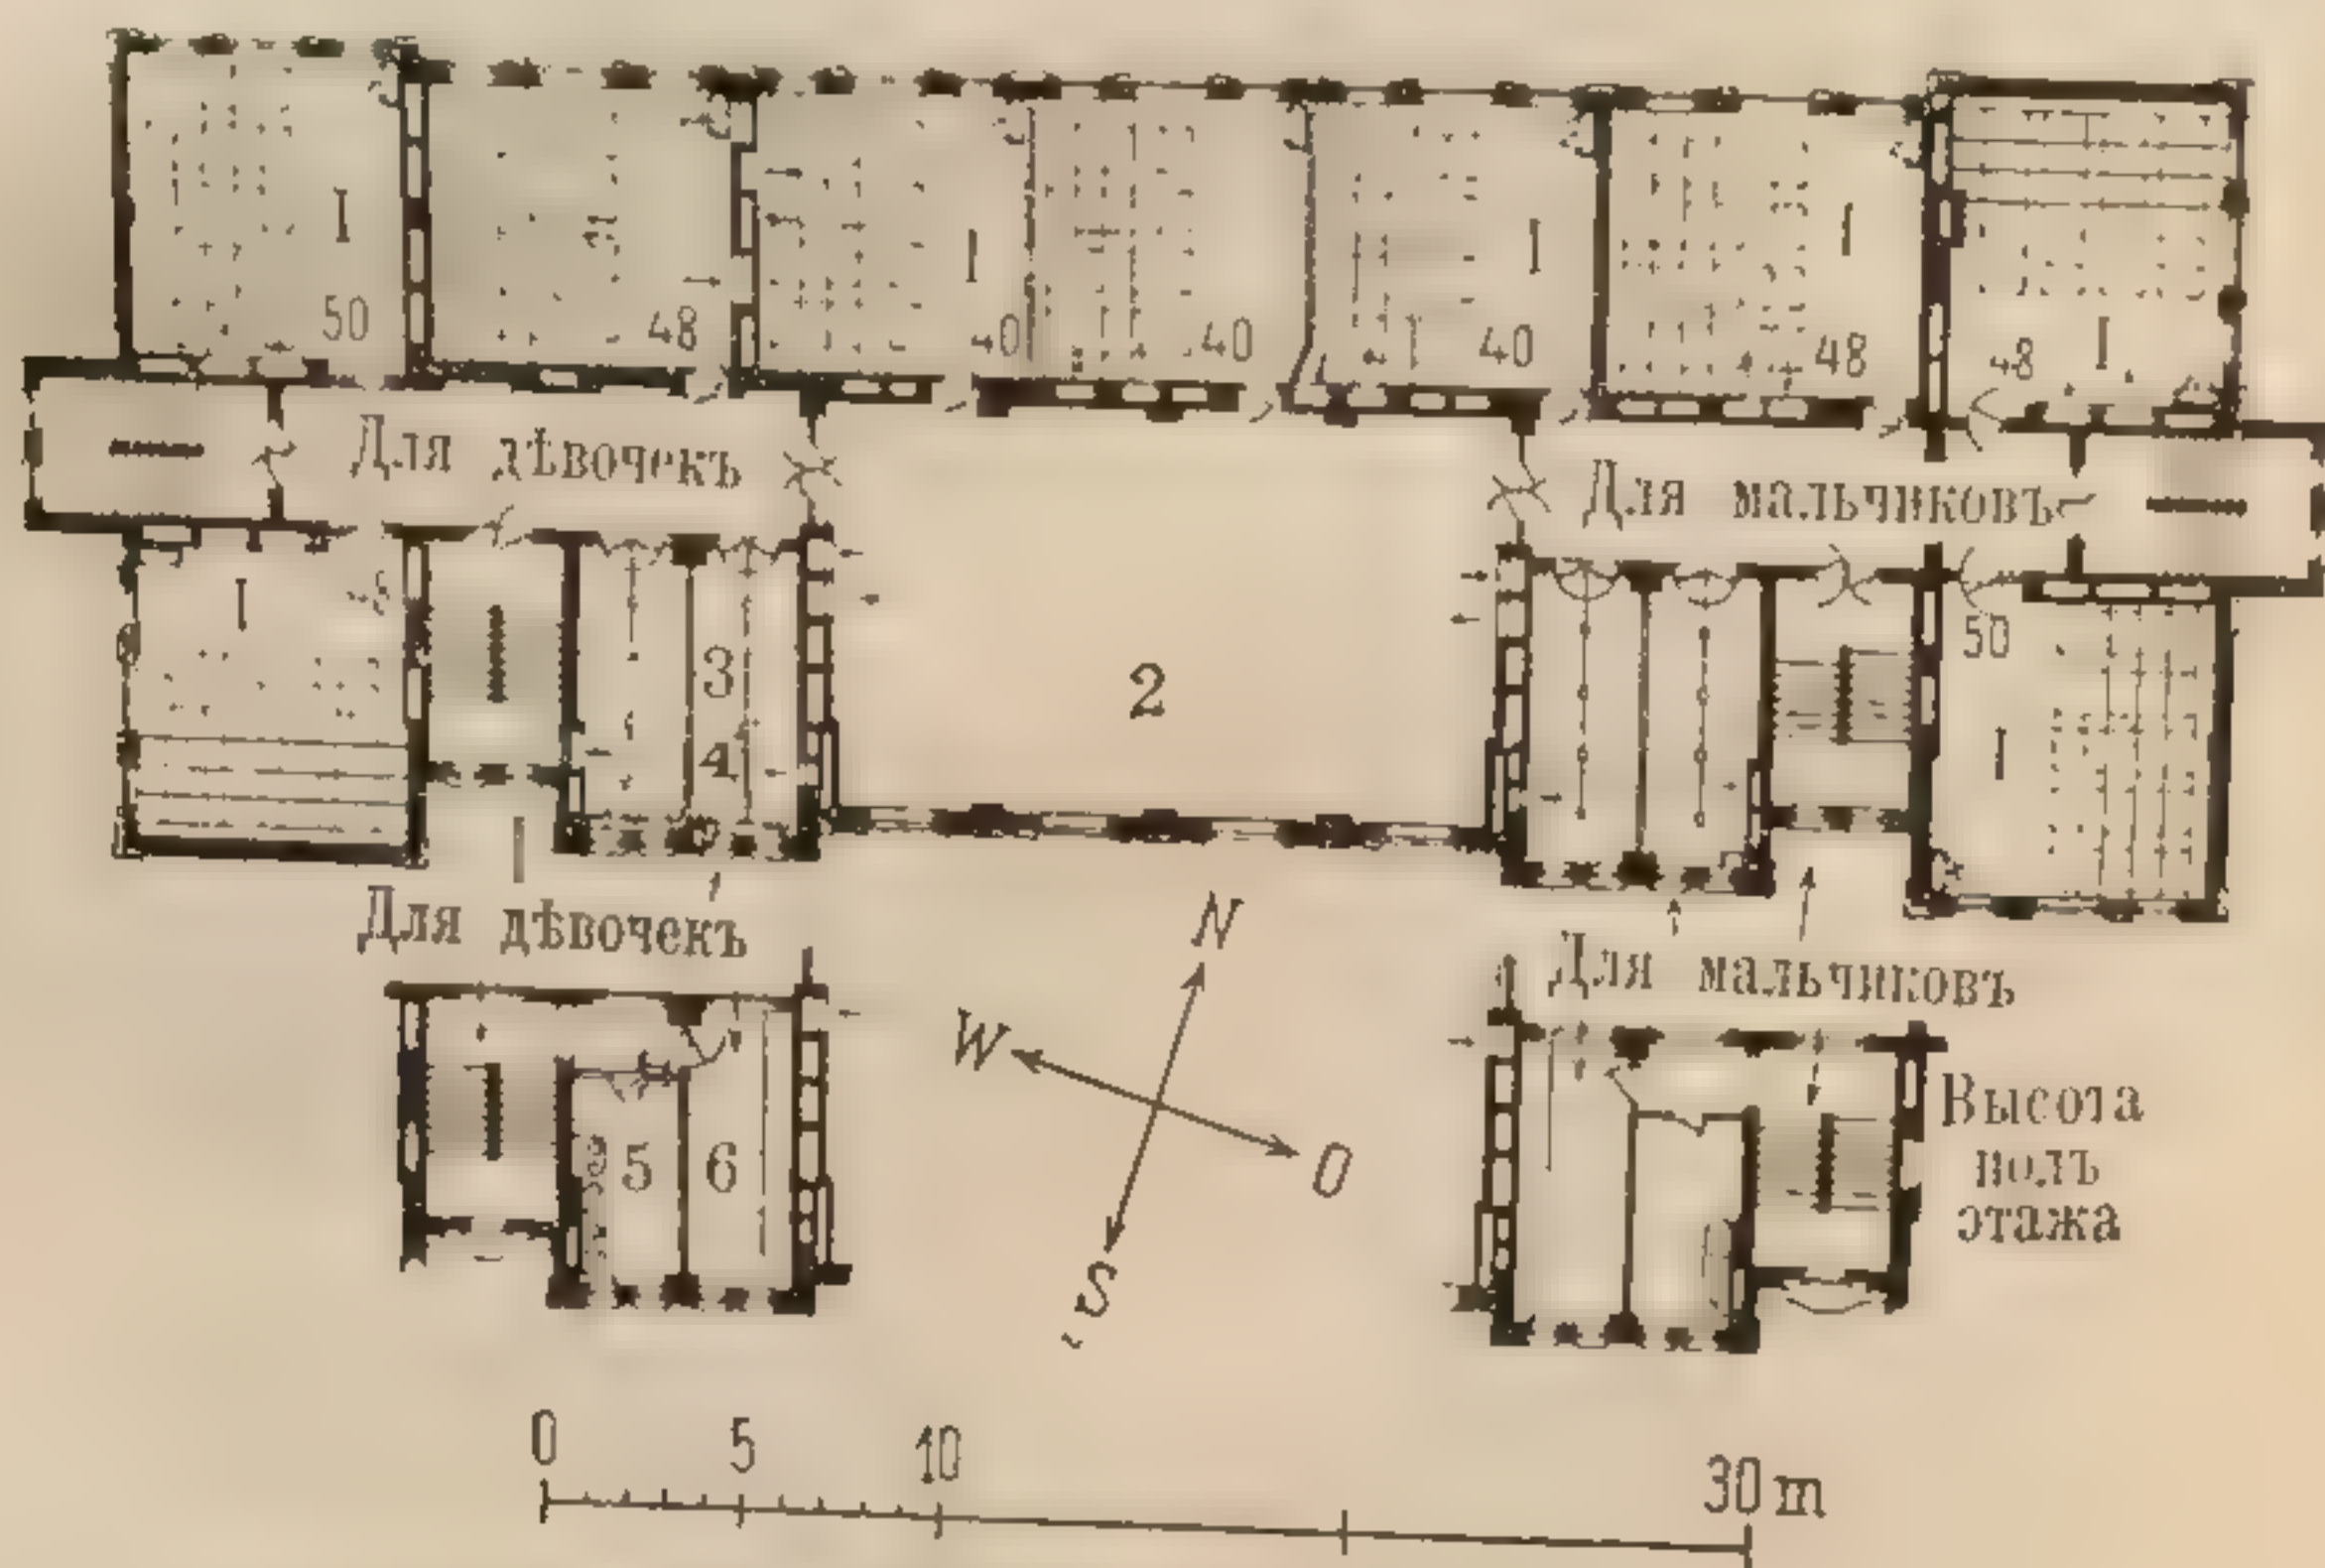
Планъ нижняго этажа higher grade school, Cassland road, London, по Bailey.
